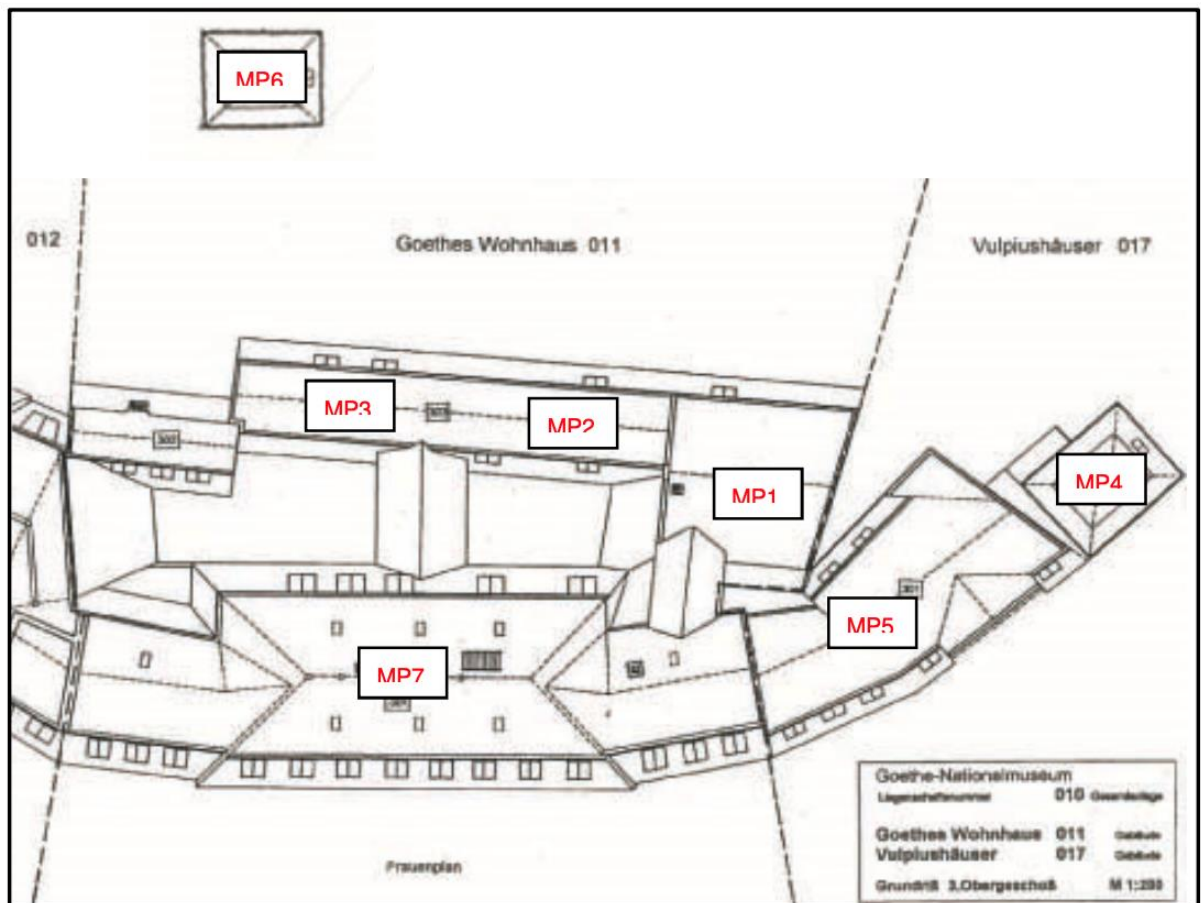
Grundriss des Prüfobjektes mit Probenahmepunkten im Dachbereich
